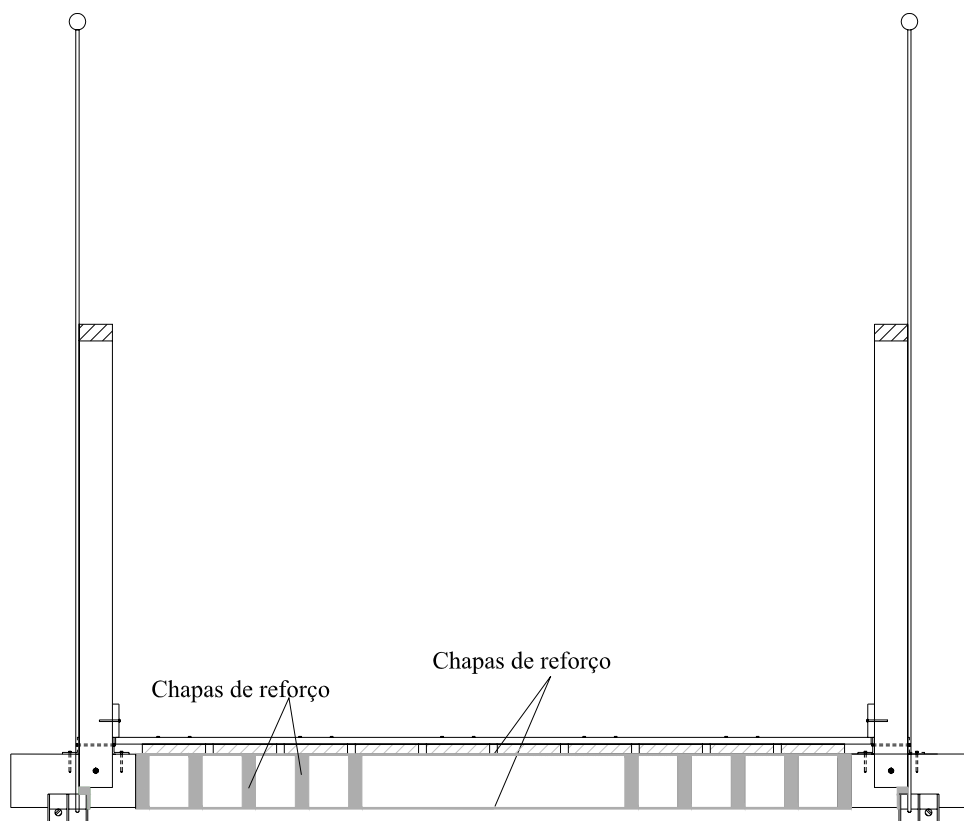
Secção transversal na zona de passagem dos tirantes sob o pavimento.
